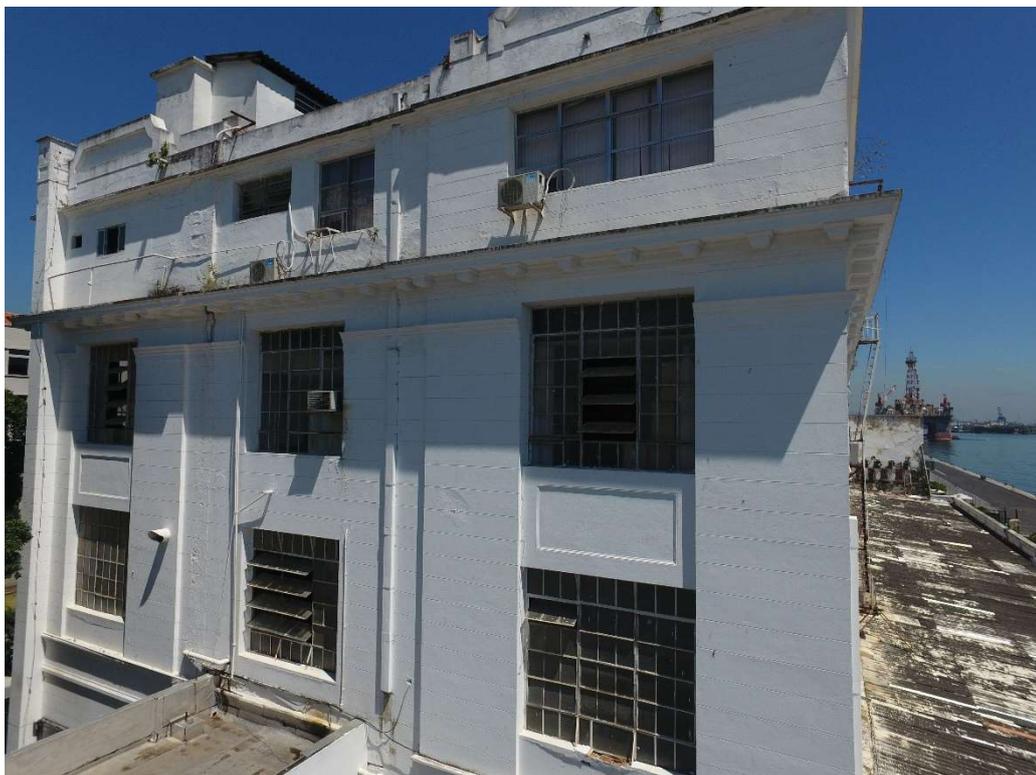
FOTO AÉREA - Fachada Lateral SUPRIO com umidade nos beirais, na platibanda, presença de vegetação na fachada (platibanda e 3 andar) e com tubulações de dreno e alimentação do ar condicionado instaladas de forma desordenada e sem suporte (Causa: falta de manutenção e limpeza da fachada / Solução: realizar reforma da fachada)
